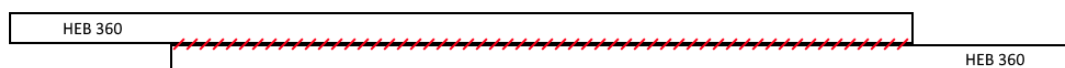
Disposición en Planta de los Perfiles 2xHEB 360
